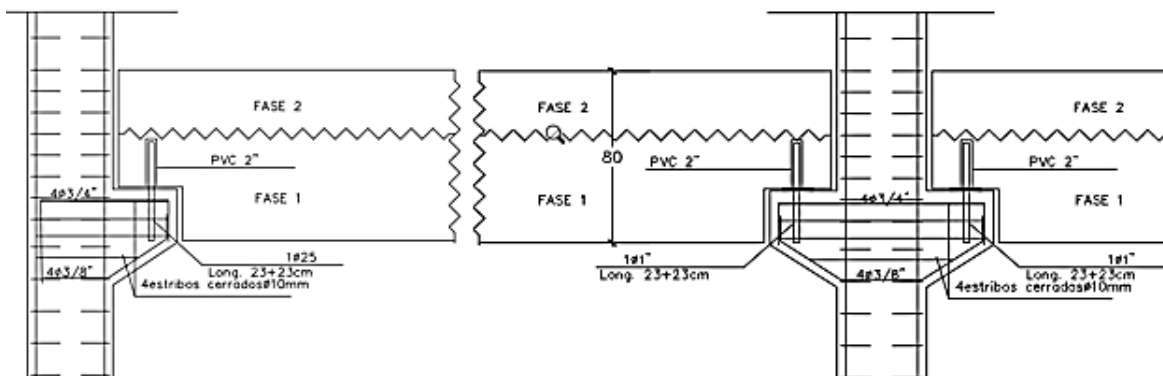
3. Alzado de armados de columnas y ménsula respectivas
